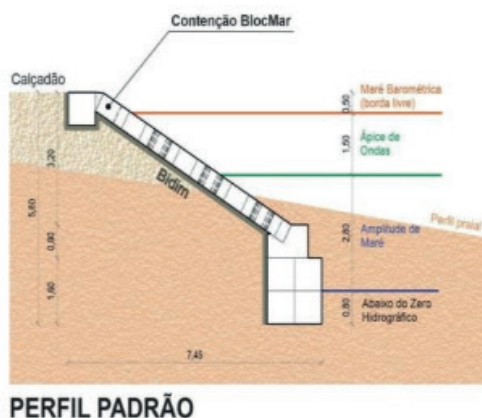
Ilustração da contenção com aplicação de anéis hexagonais
